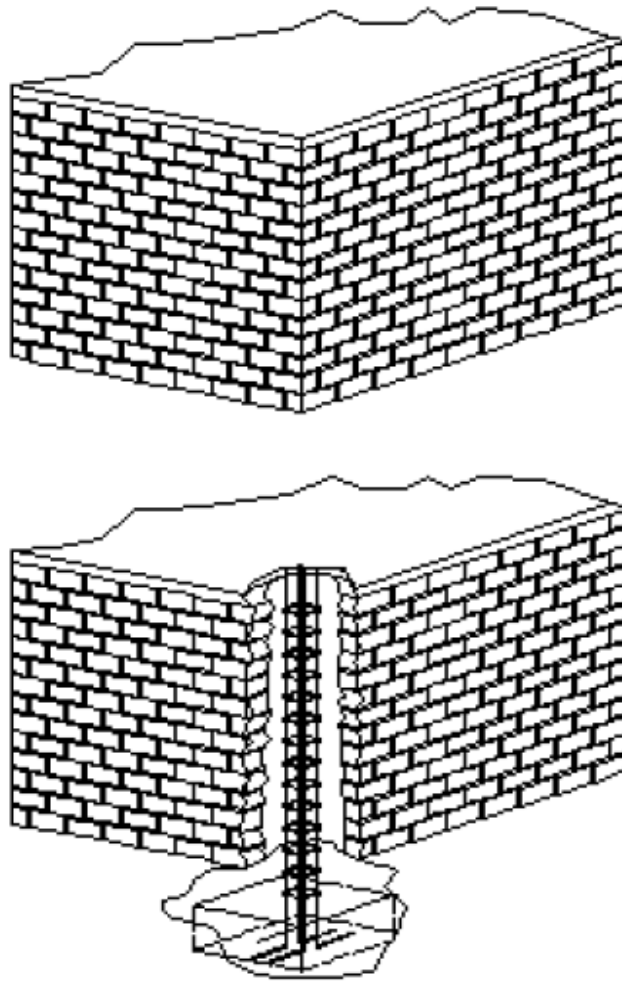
Detalle de inclusión de columnas de reforzamiento en muro sin confinamiento existente.
